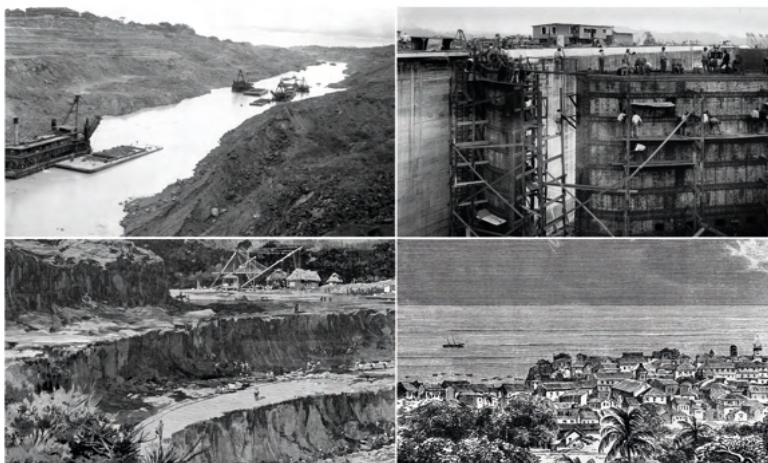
Dragas trabalhando na construção do Canal do Panamá; homens na construção de uma das eclusas do canal; escavações na tentativa francesa de construção do canal; vista da Cidade do Panamá em 1878.
